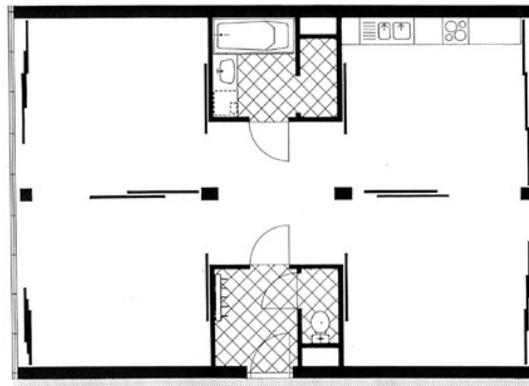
Grieshofgasse - Grundriss einer Wohnung
